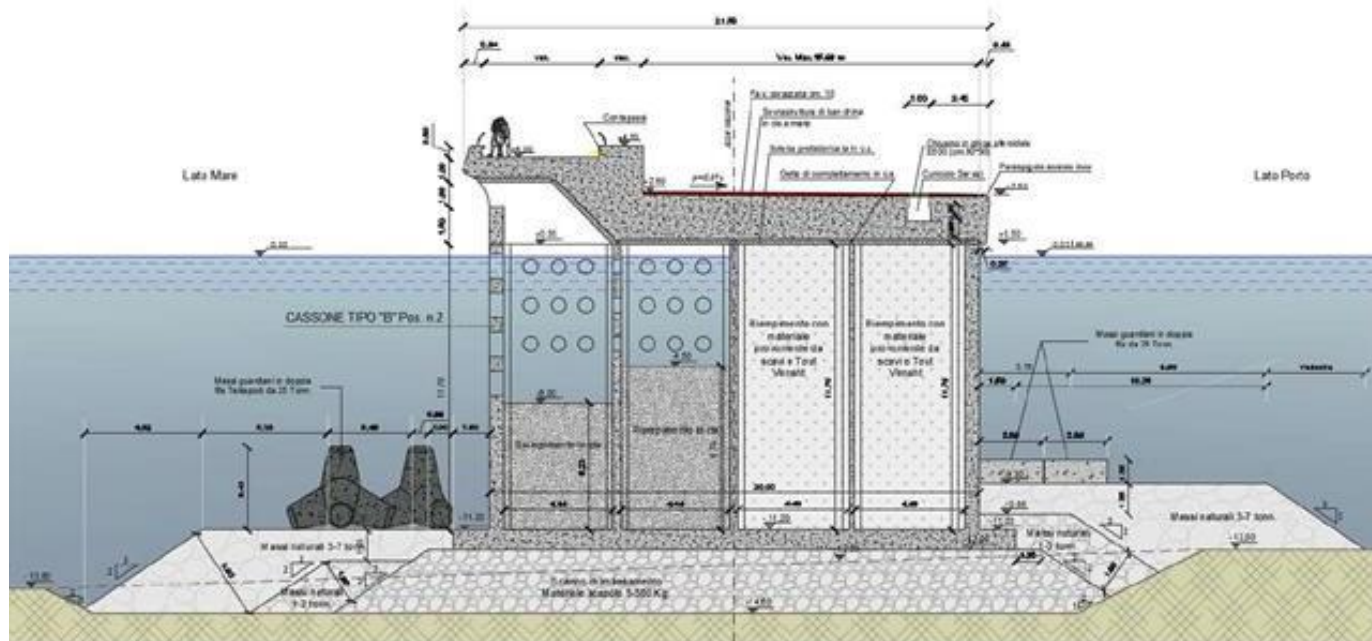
Sezione tipo B-B (Cassone tipo B)
